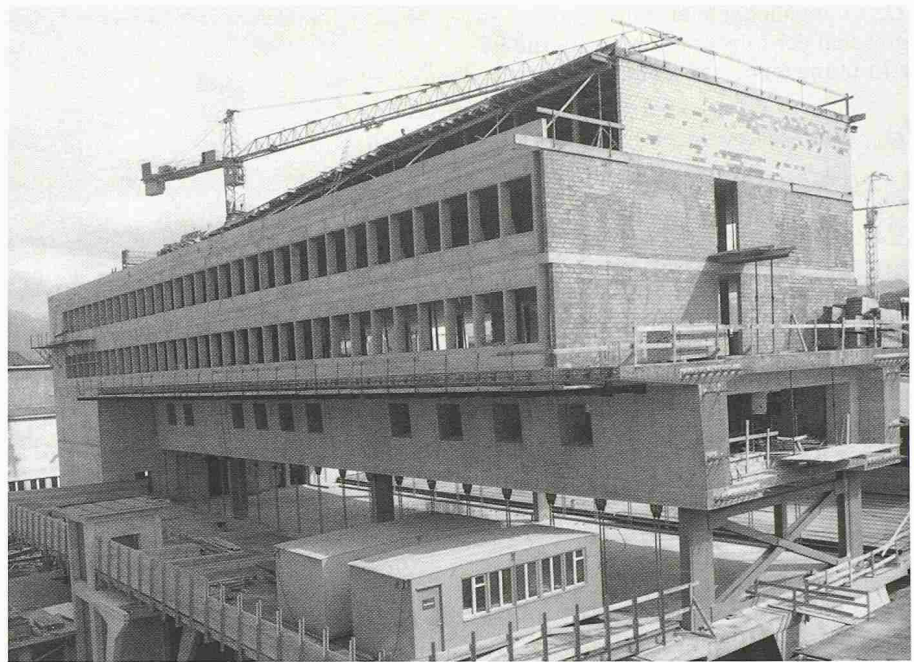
Gesamtübersicht mit Brücke im Bauzustand, ganz unten die aufgehängte Zwischendecke über EG (Foto E. Kneubühler, Kriens)
